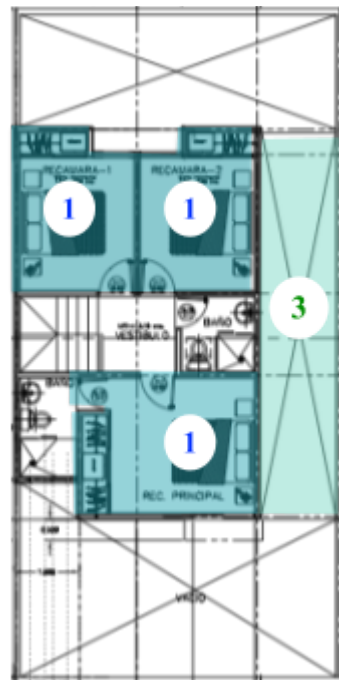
Planta baja donde se muestra la propuesta. ( ver punto número 1y 3).
